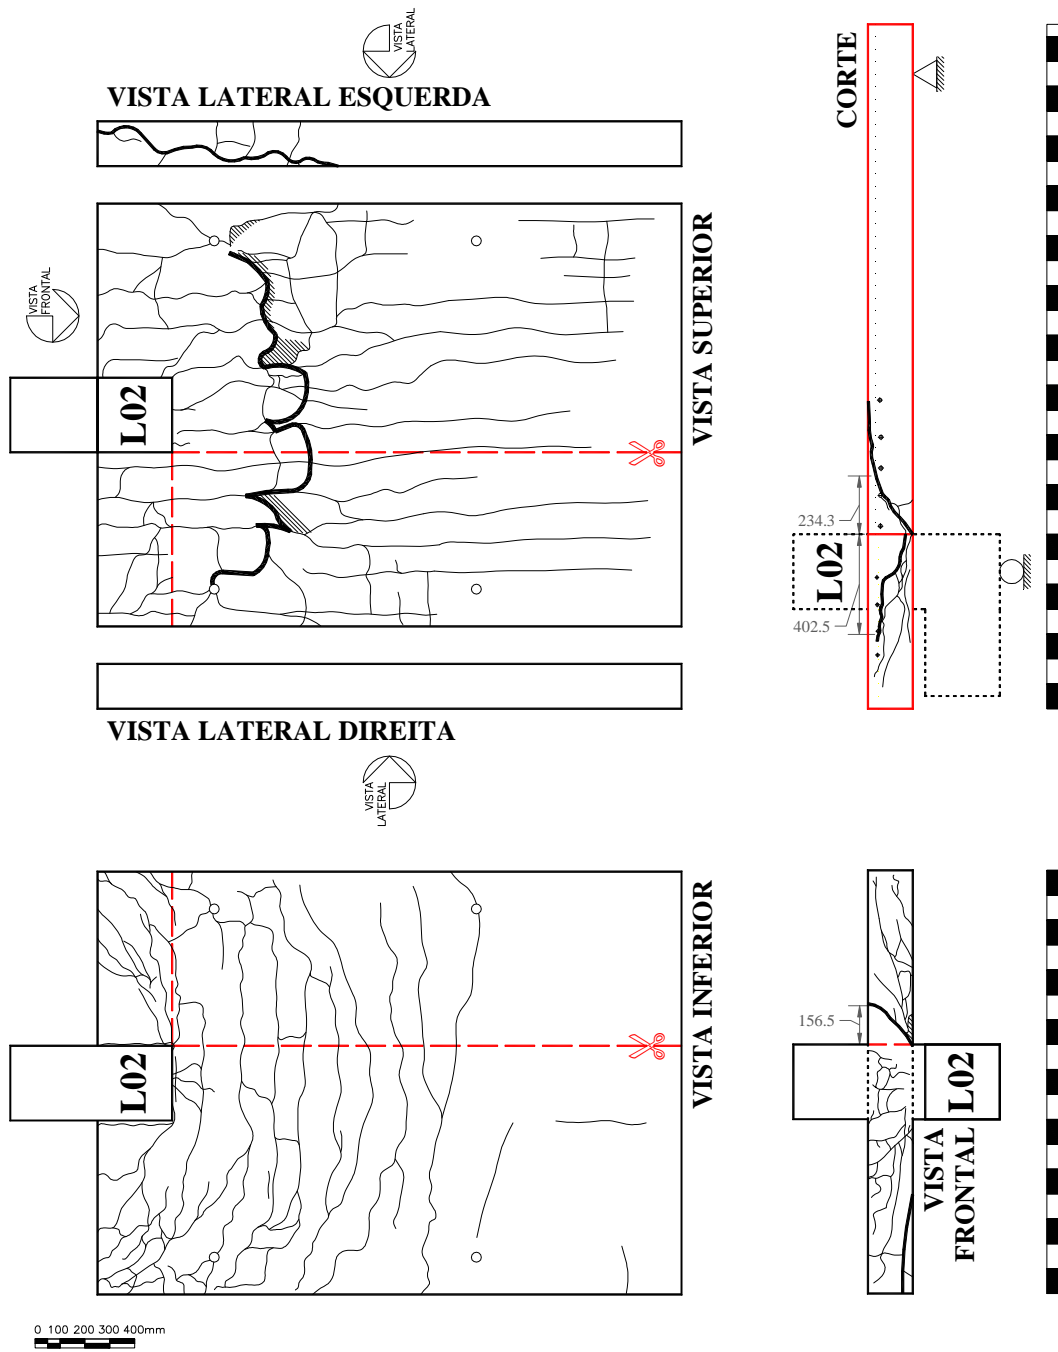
Padrão de fissuração da laje L02
